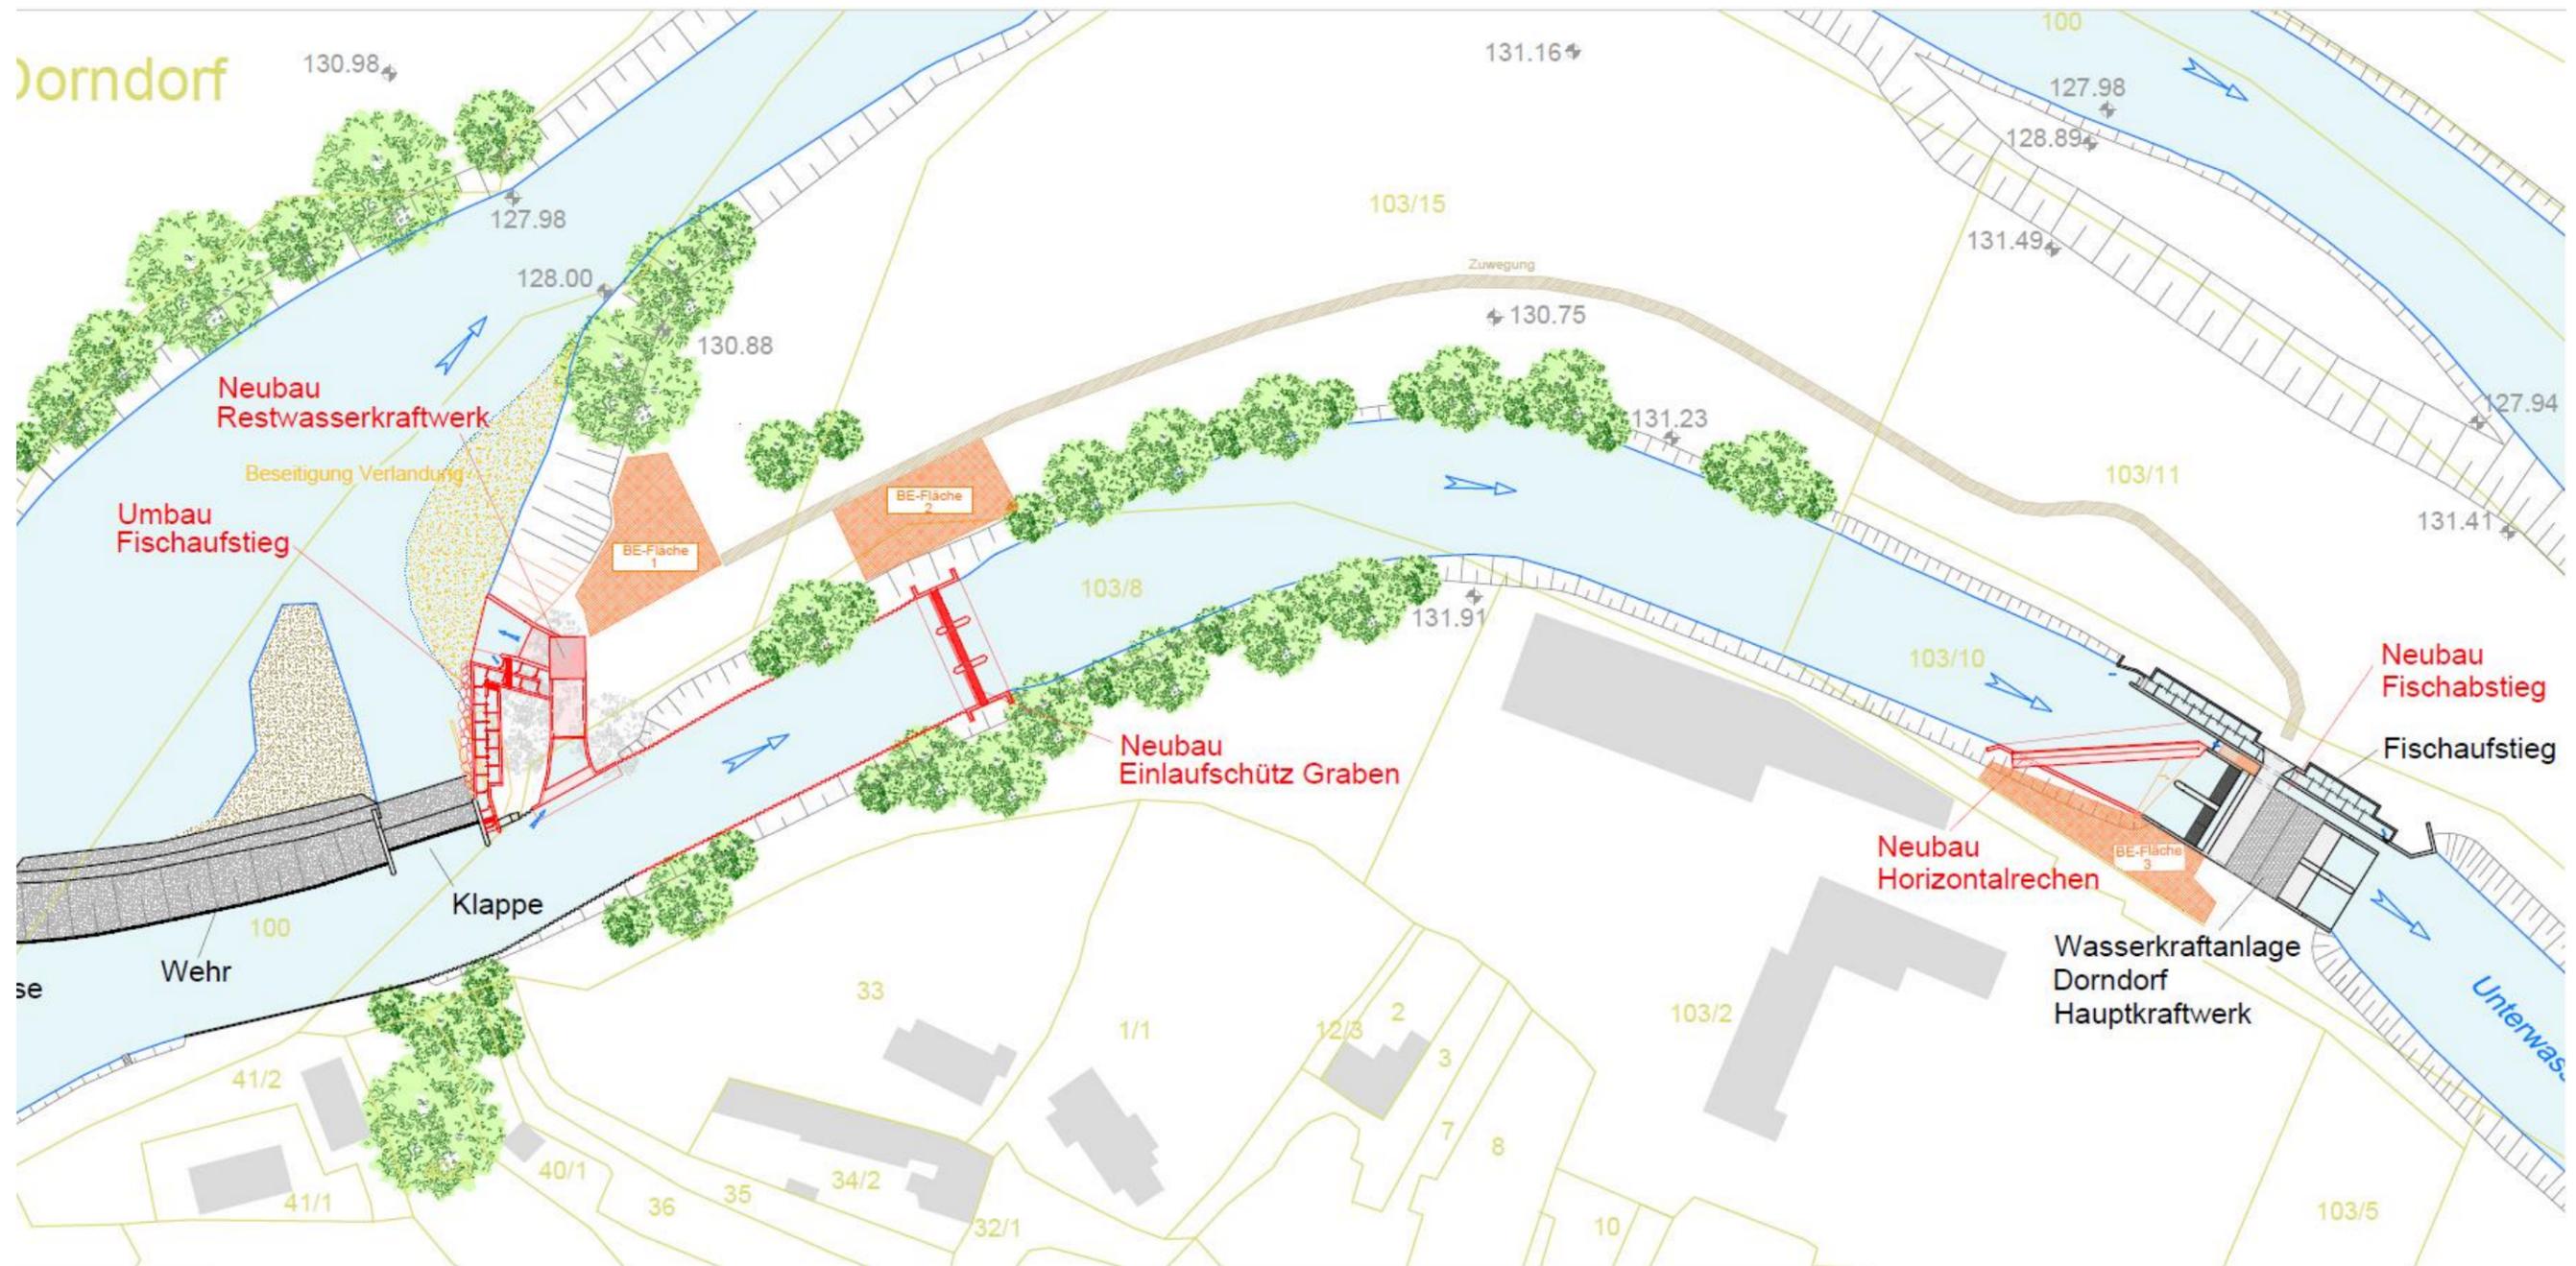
Lageplan Bauvorhaben (aus: Planungsunterlagen der IGW mbH)
